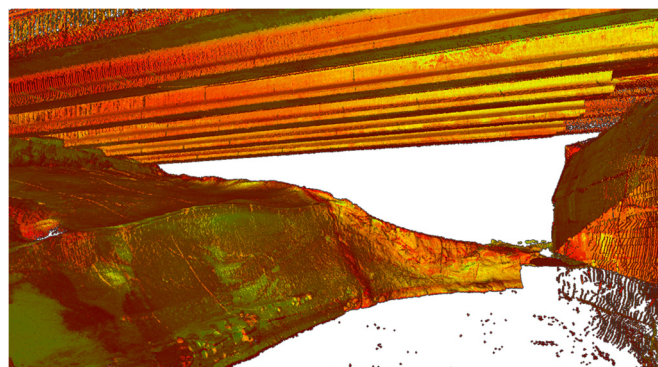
Облако точек для типового железобетонного пролётного строения моста
